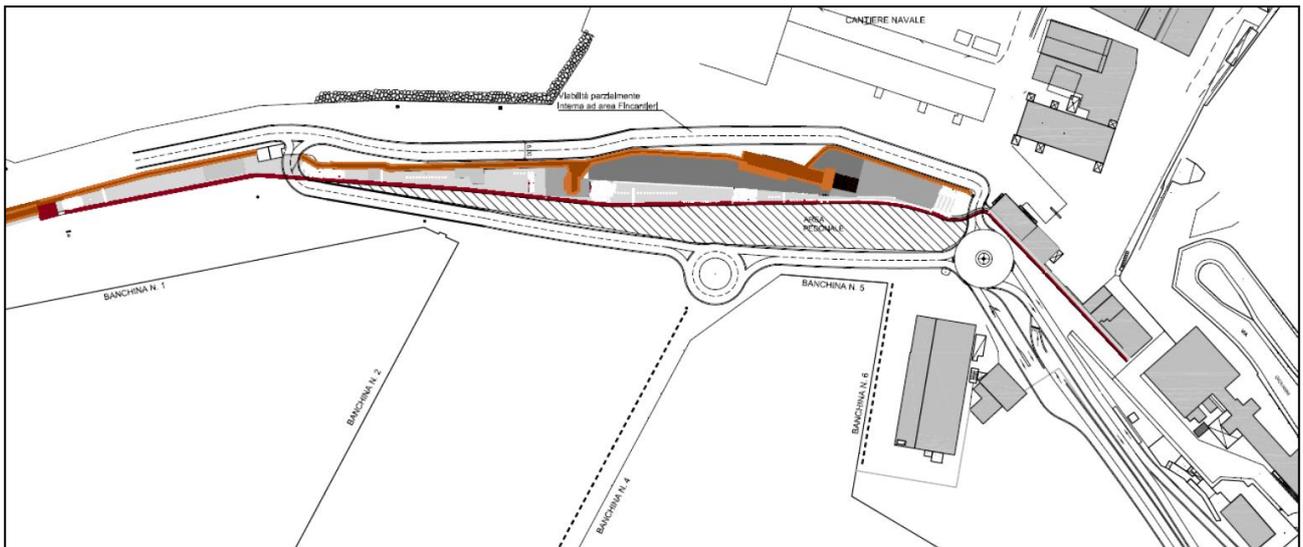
Planimetria generale di progetto SOLUZIONE 2 con retrobanchina.
